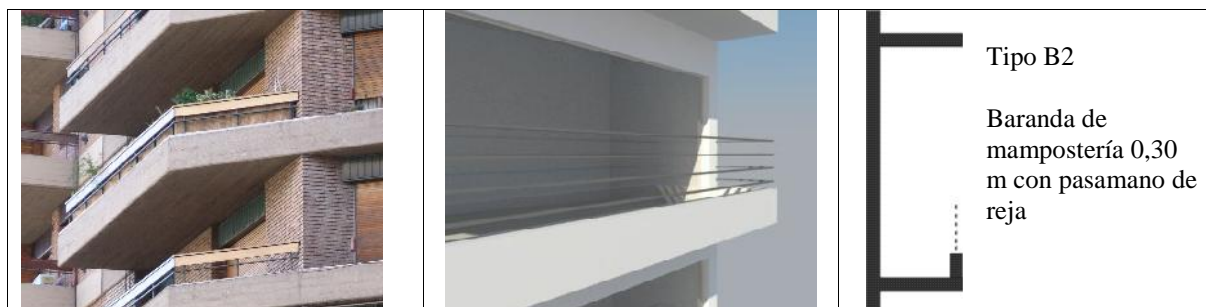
Balcón tipo B2 – baranda de Mampostería y reja
